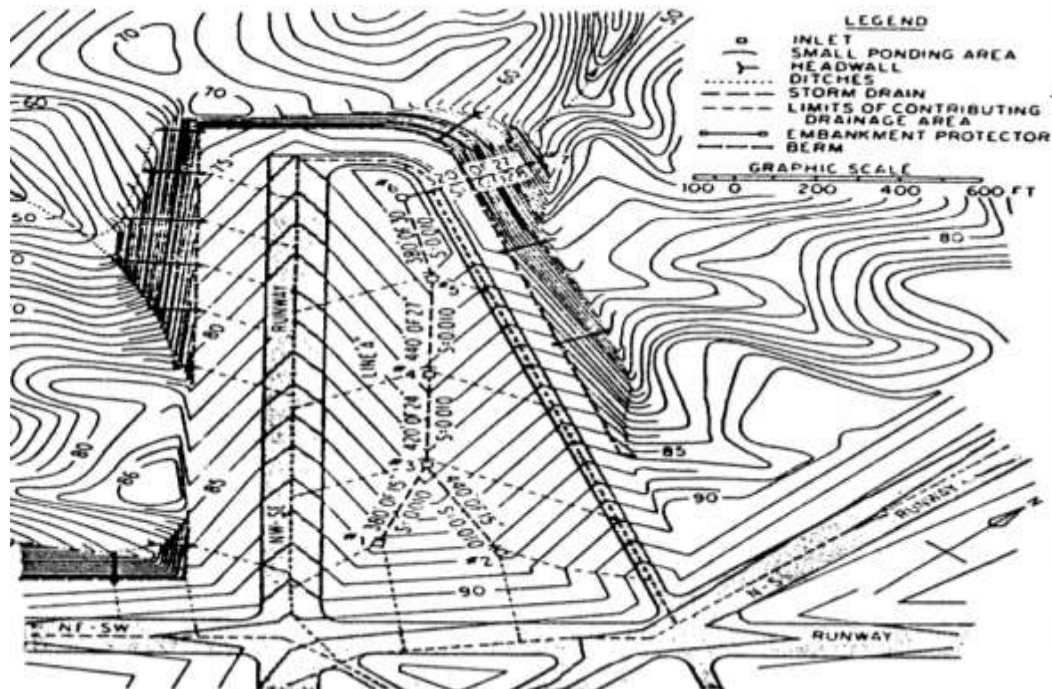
Sistem Drainase Lapangan Terbang
